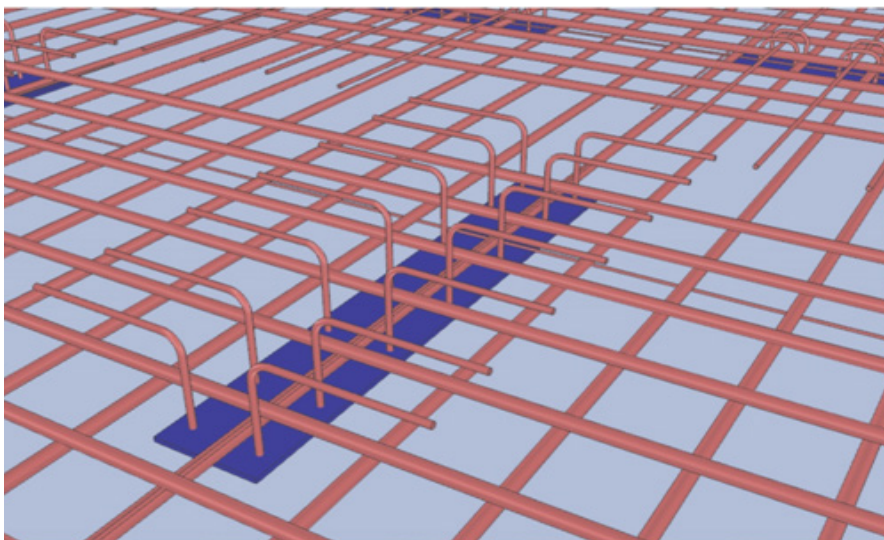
Узел установки закладной детали в армоконструкцию плиты перекрытия
